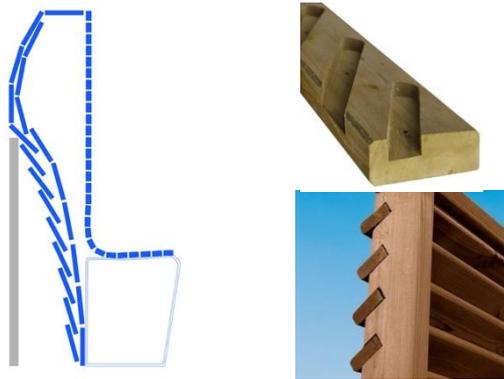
Coupe du premier principe constructif (hauteur : 1,4 m) accompagnée de photos d'assemblage.
